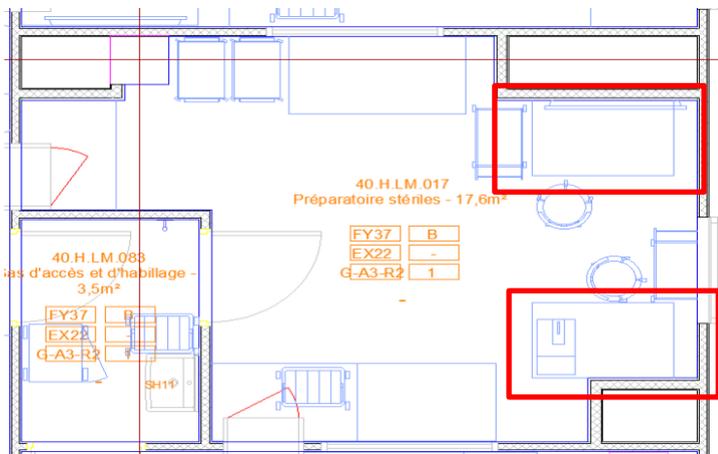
Plan Architecte AS ; sont constatés, les microimplantations
